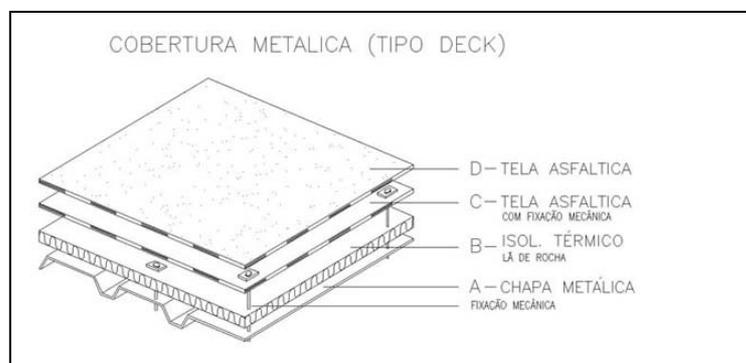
Cobertura tipo deck com fixação mecânica da tela
